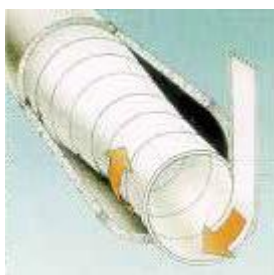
Instalação Mecânica em Espiral Apertada [6]
